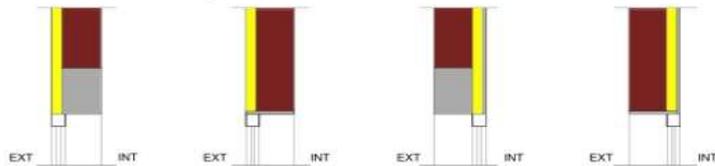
Dinteles con continuidad entre el aislamiento de fachada y la carpintería.
